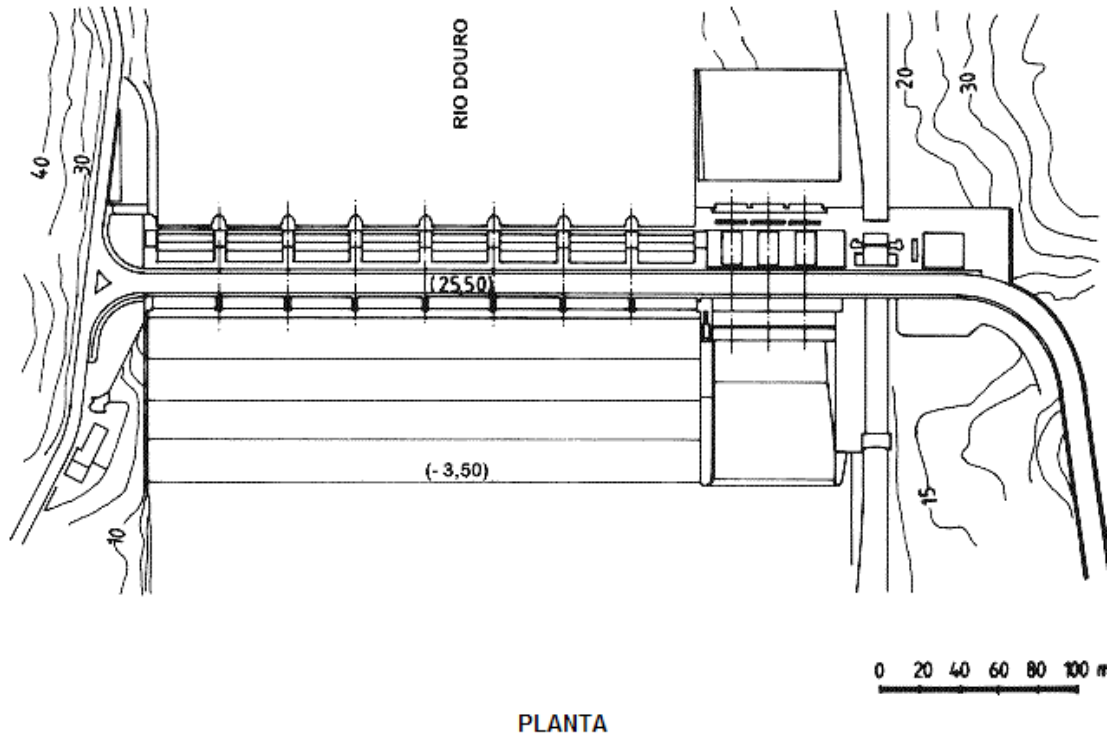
Barragem de Crestuma-Lever – Planta [4]
